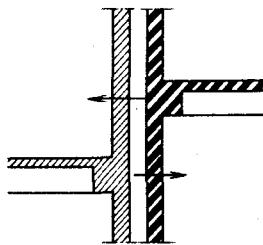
Возможность повреждения в уровне перекрытий расположенных рядом зданий
